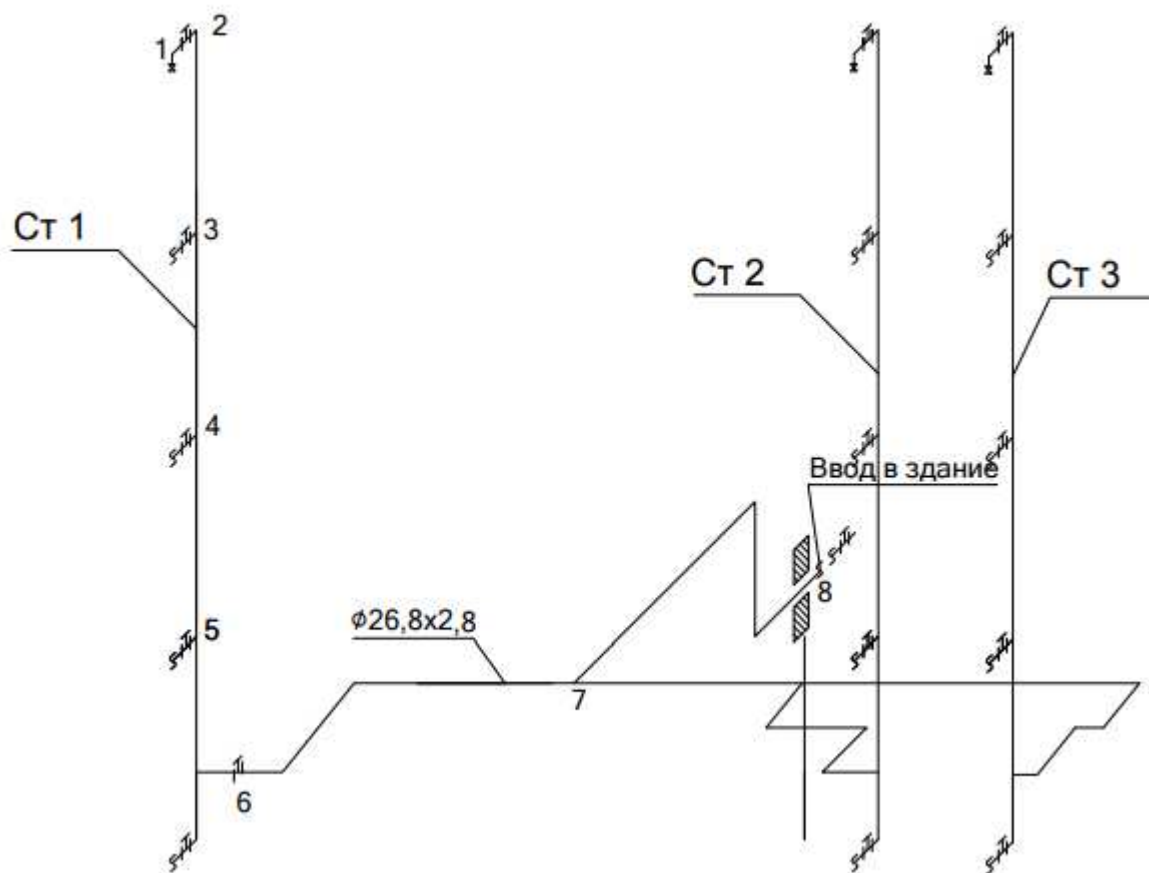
Расчетная схема внутридомового газопровода
